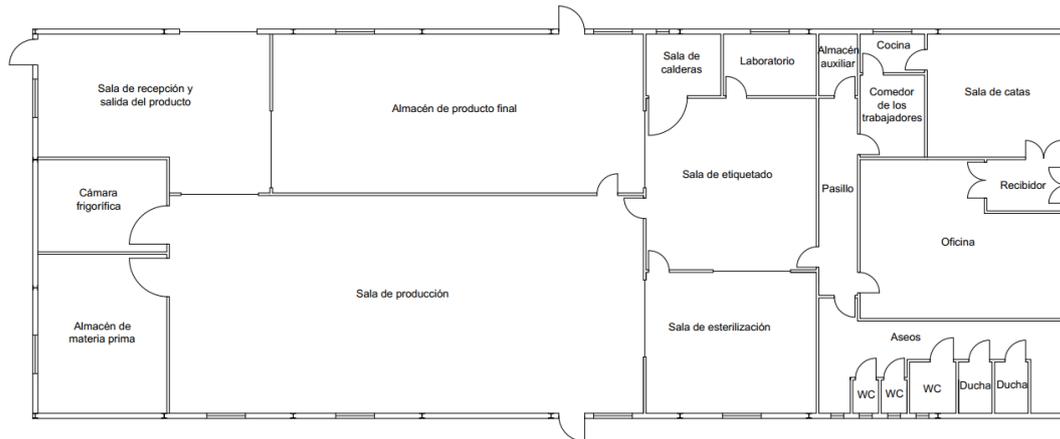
Planta del edificio. Fuente: elaboración propia.
